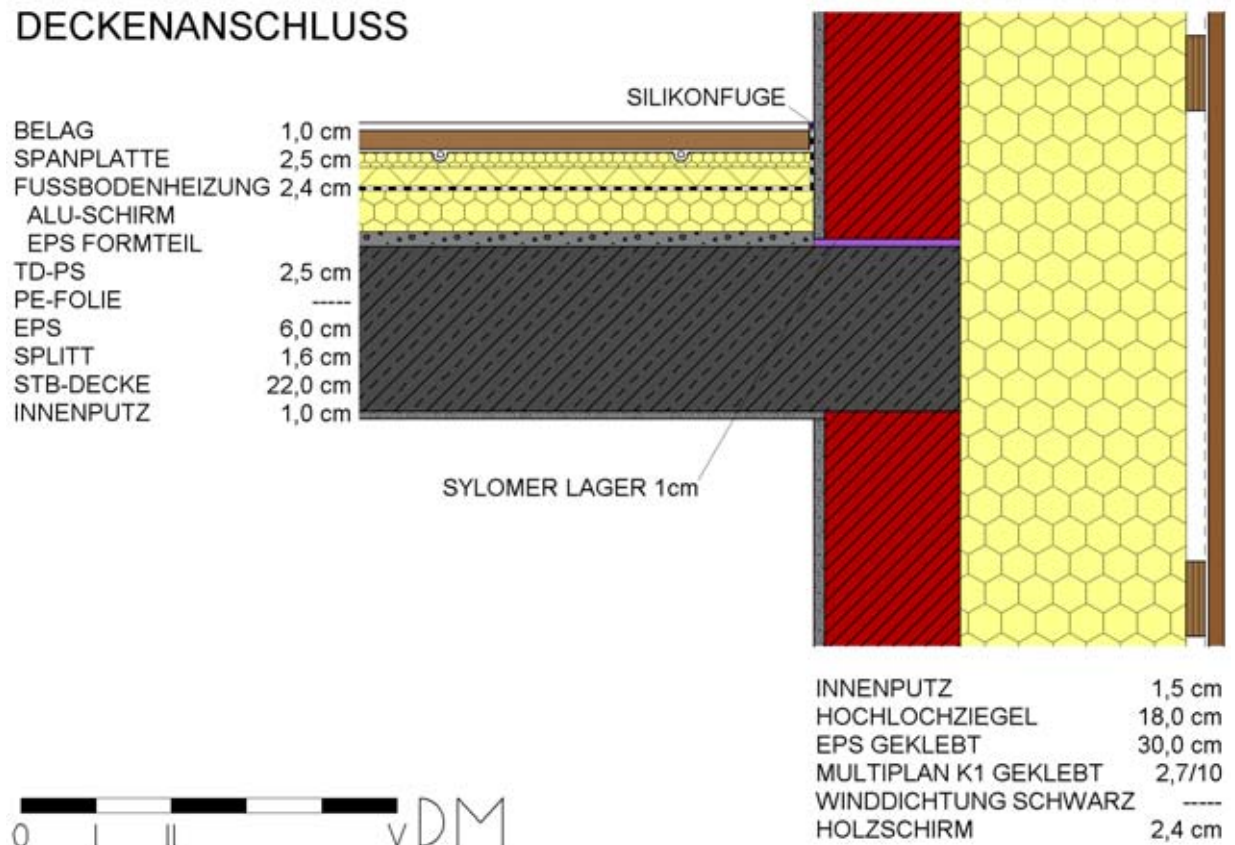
Detail Anschluss Geschossdecke - Außenwand
